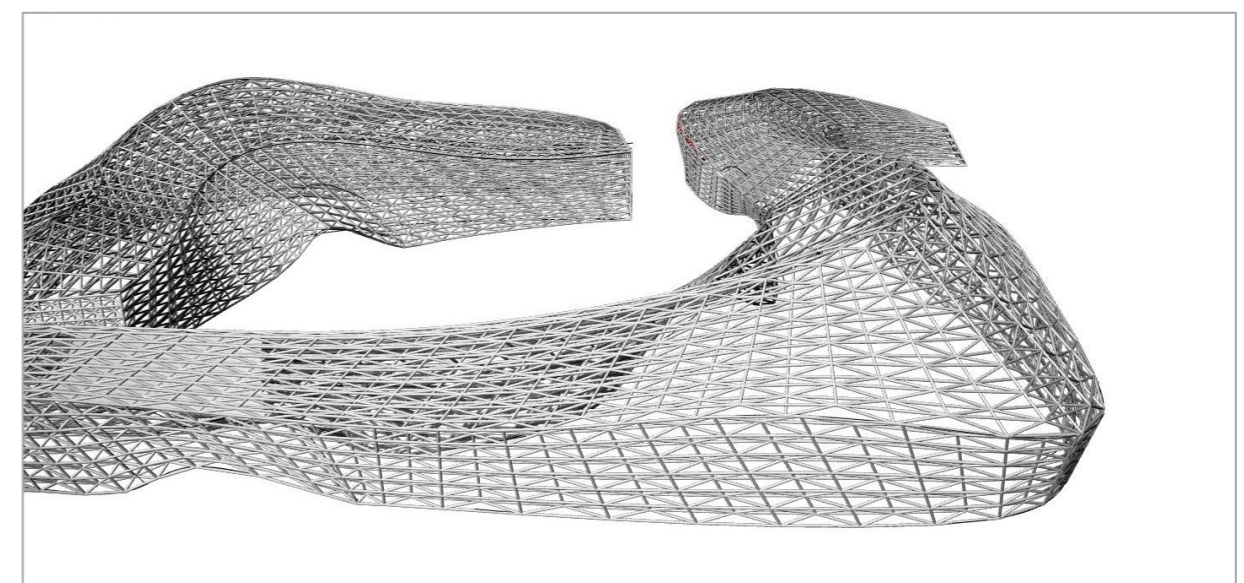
Schéma de la structure tridimensionnel de notre projet. Source : fait par
